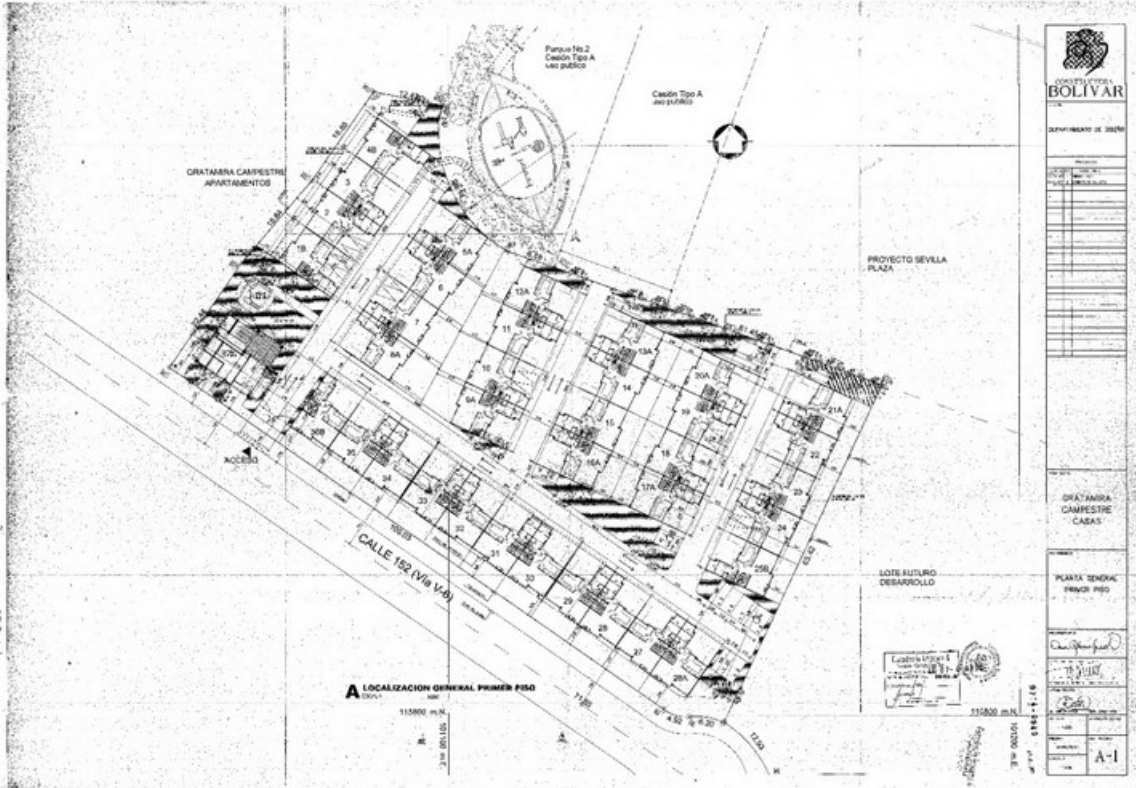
Plano de localización del conjunto Gratamira Campestre Casas en el PPRU El Tomillar.
